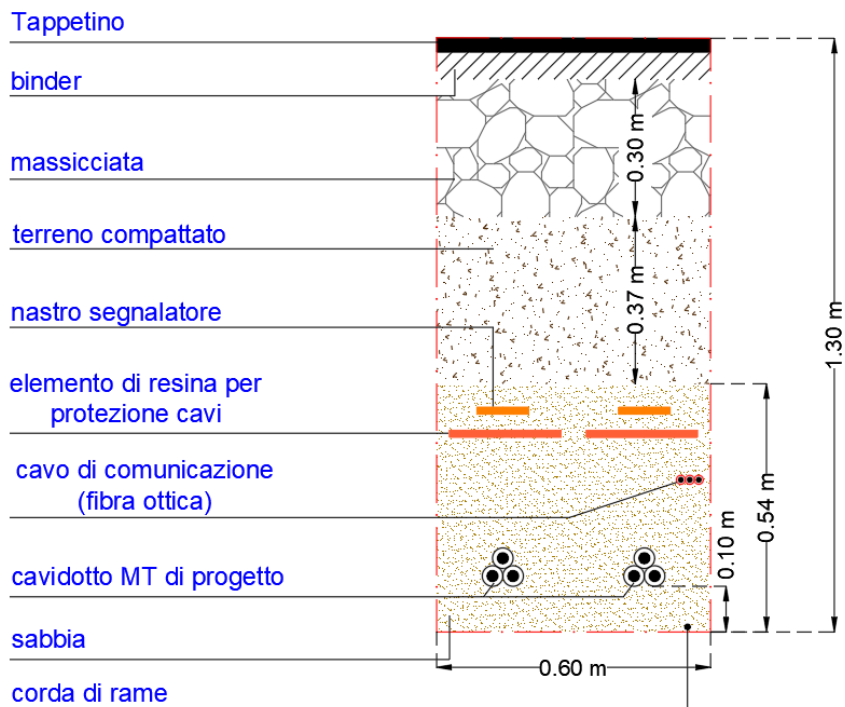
Sezione Cavidotto Doppia Terna su Strada Asfaltata
